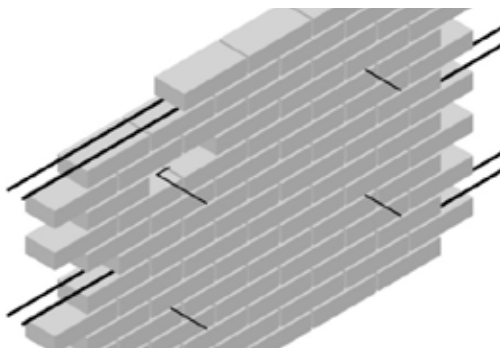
Placering av armering och kramlor i fasadparti utan muröppningar.
